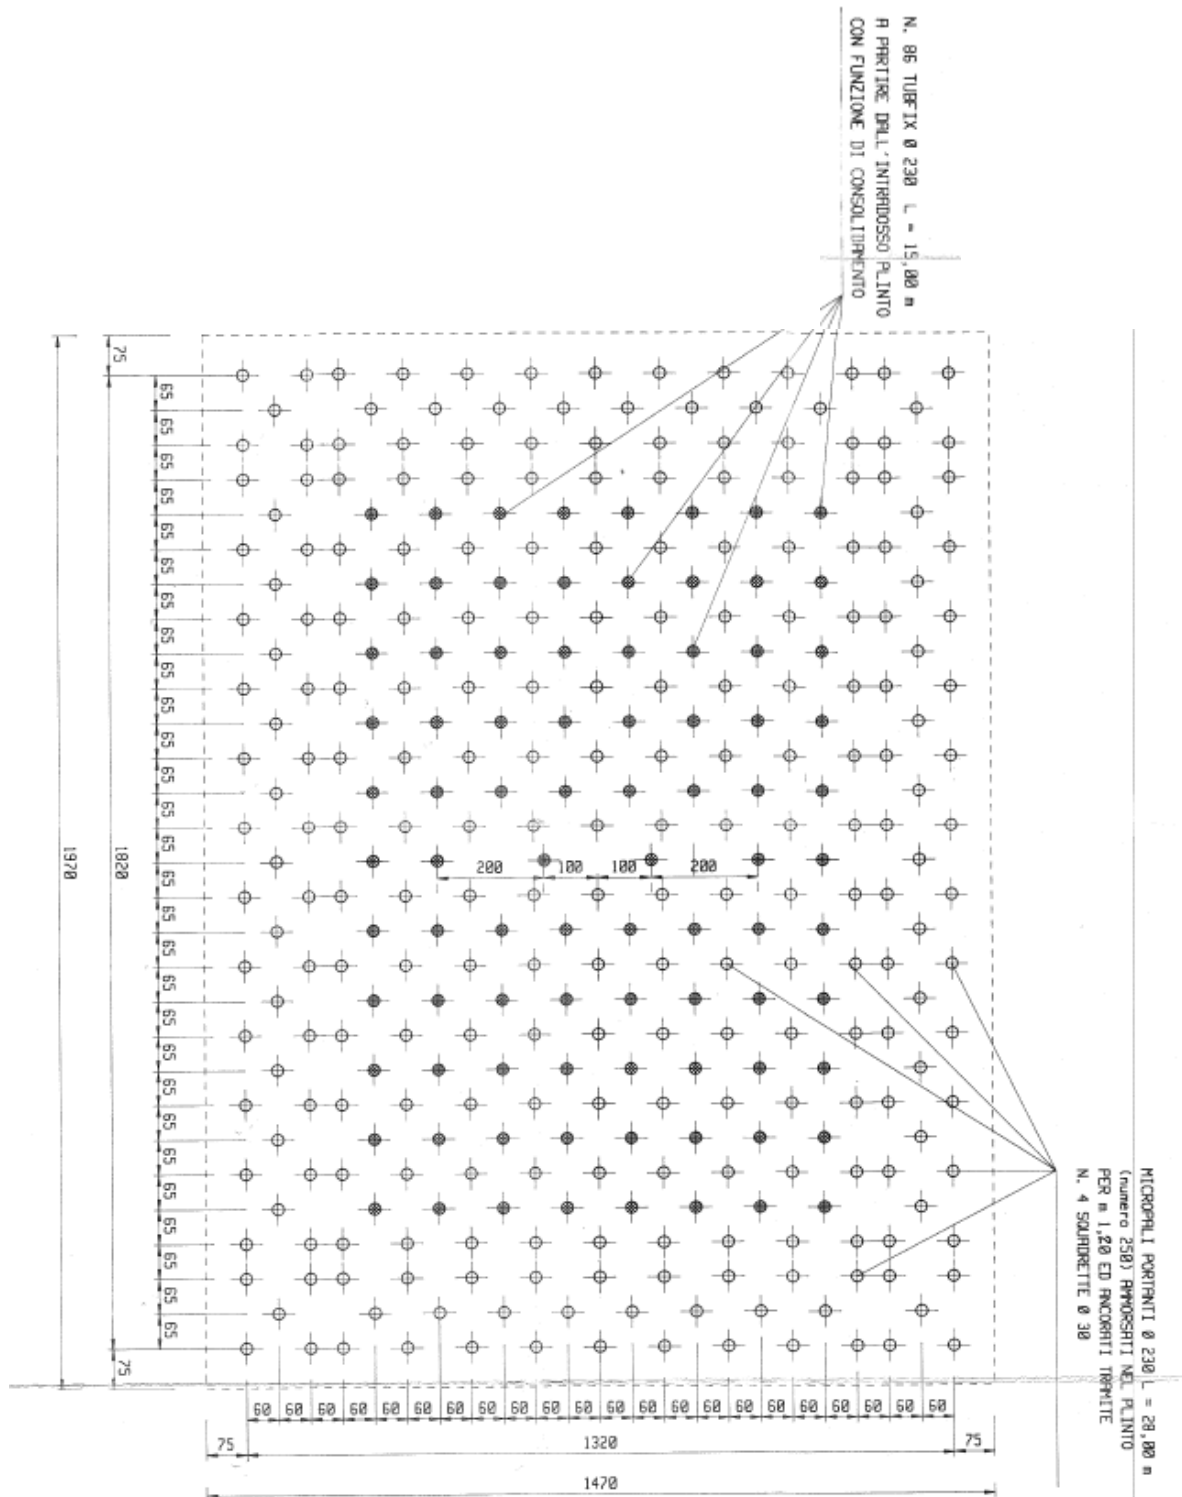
Pianta pile P21÷P22 su fondazione diretta con 250 micropali
